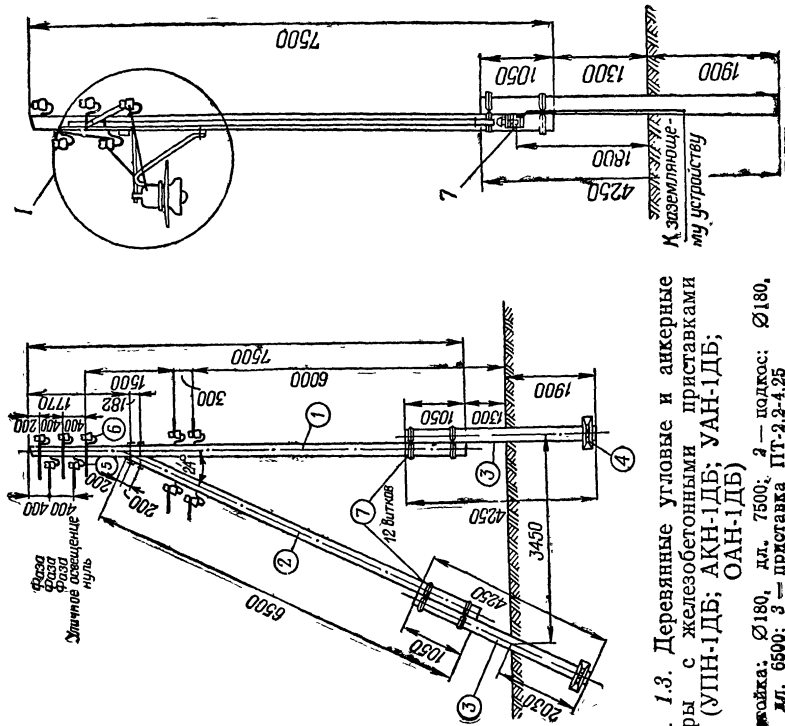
Деревянные угловые и анкерные опоры с железобетонными приставками (УПН-1ДБ; АKN-1ДБ; УАН-1ДБ; ОАН-1ДБ)
